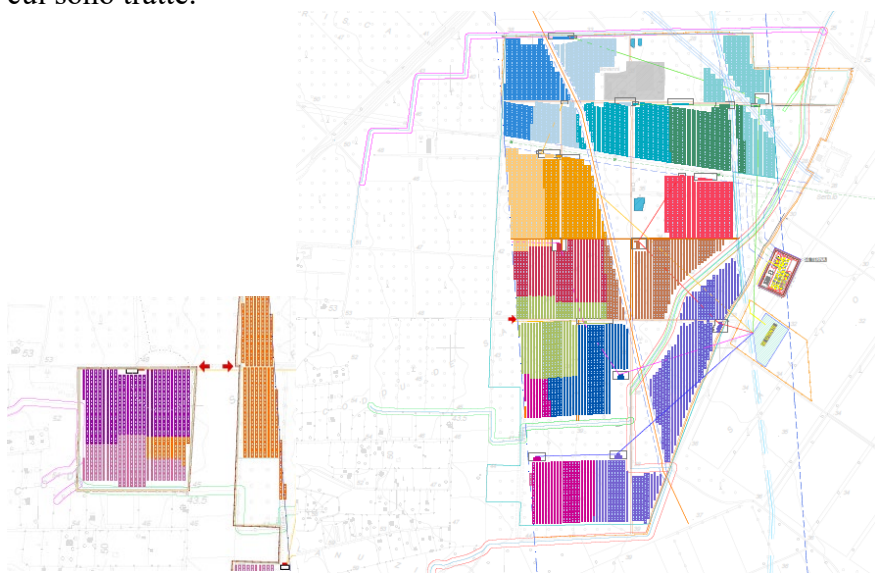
Estratti dalla planimetria d'impianto del Lotto A e B
